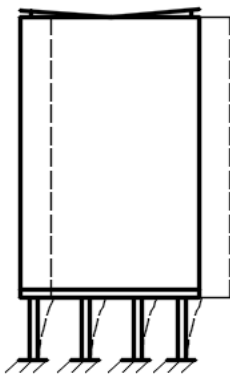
Схема будівлі з першим гнучким поверхом
